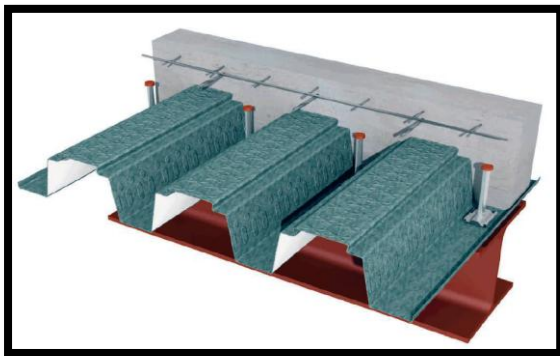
Schéma d'un plancher collaborant ¹⁵⁸
